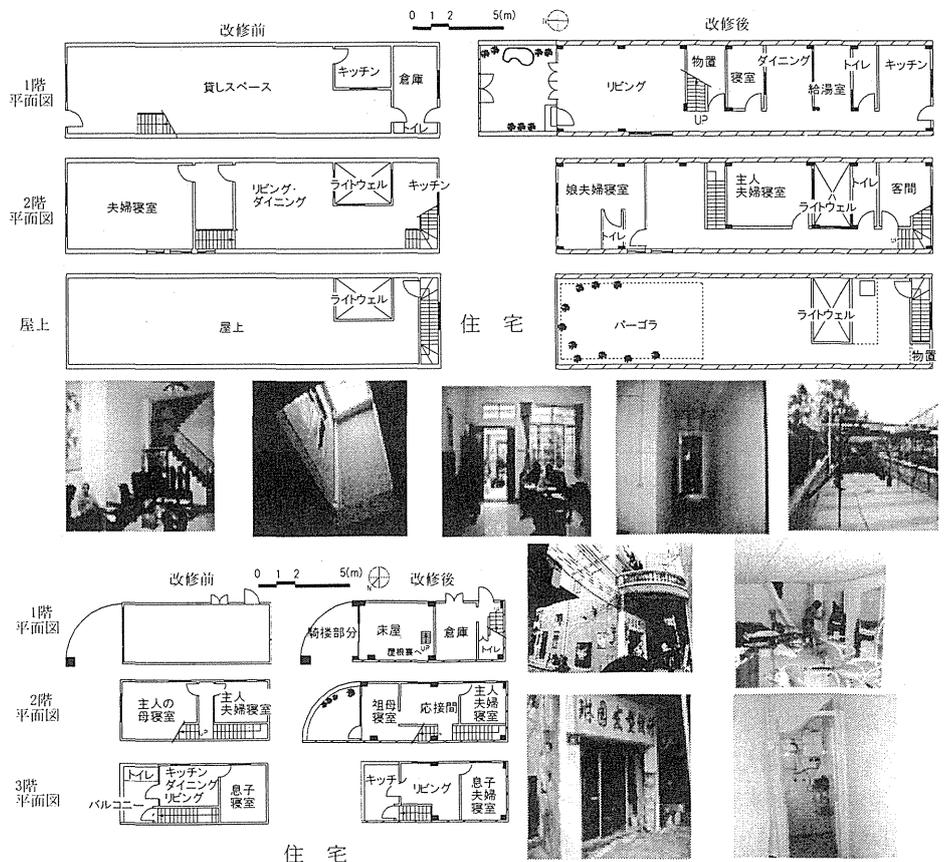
住宅の建て替え・改修状況(改修前と改修後)〈上の平面図・写真5点が住宅2〉
